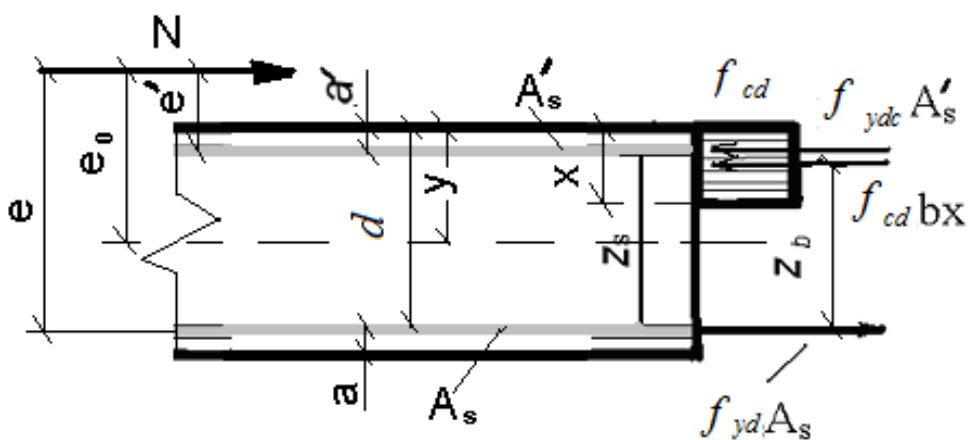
Схема зусиль, які виникають у балці з подвійною арматурою
